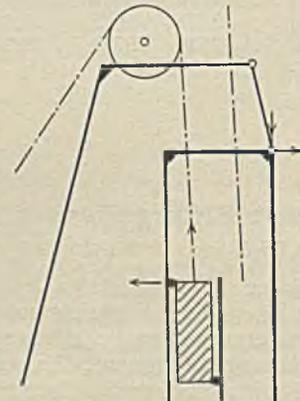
Belastung des Führungsgerüsts mit Bremswirkung auf den Förderkorb bei Schrägstellung des Pendels.
